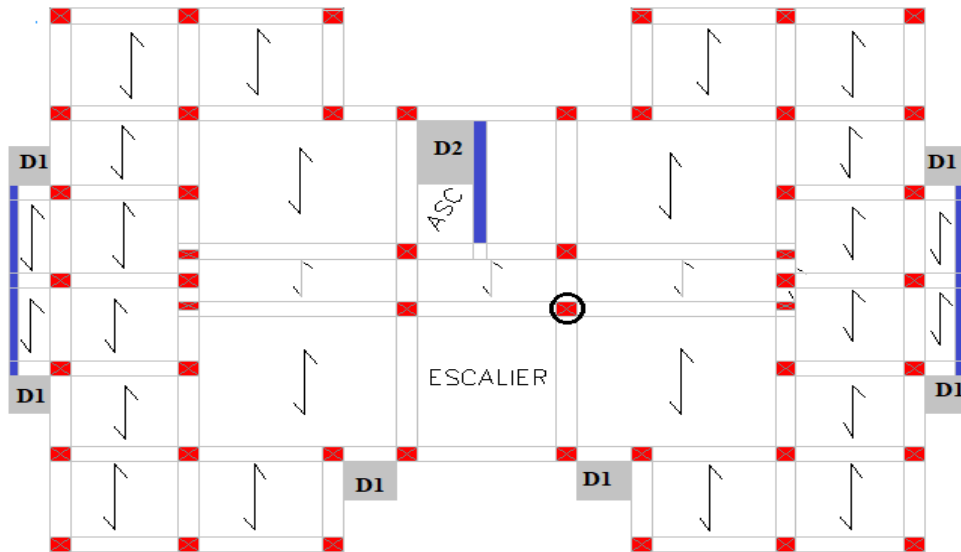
Schéma de la disposition des poutrelles pour le reste des étages et terrasse inaccessible.
